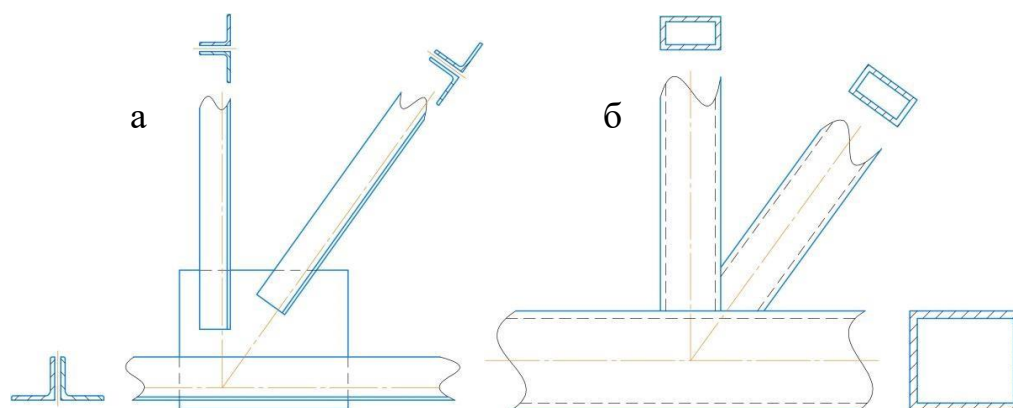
Узлы ферм: а – на фасонках; б - с примыканием элементов
